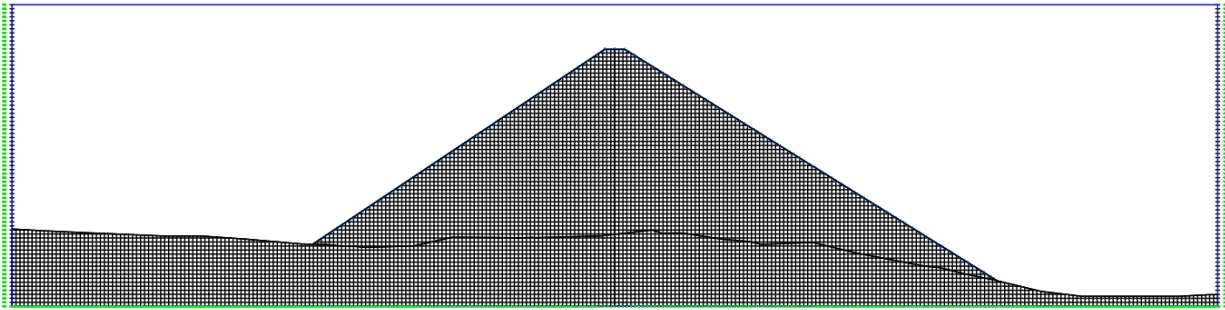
Sección Transversal Ejemplo Presa CFRD Murallas Viejas, Civil 3D
